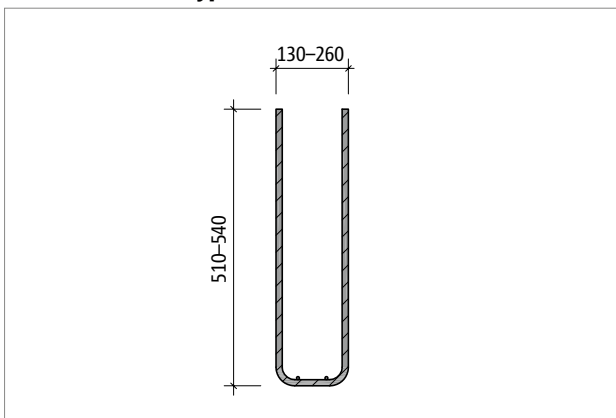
Schöck Sconnex® Typ W Part TB: Zulagebewehrung 3 Ø 12/65 mm; Bügel als Spaltzugbewehrung
